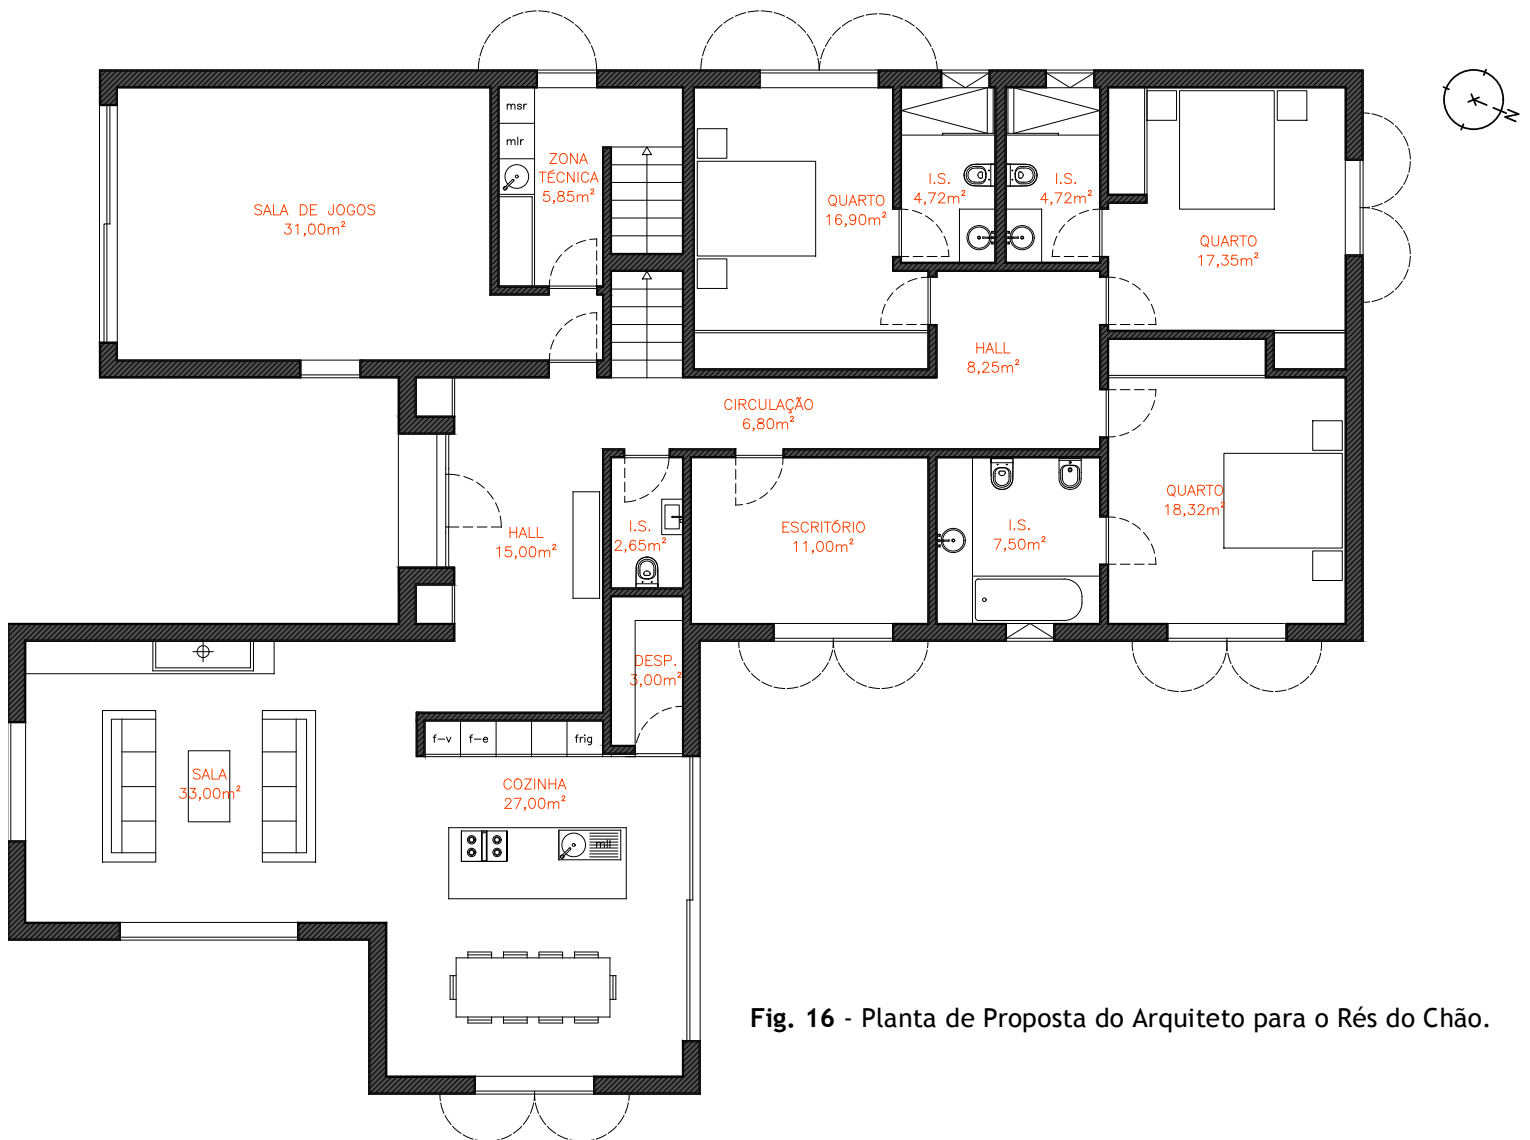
Planta de Proposta do Arquiteto para o Rés do Chão.
